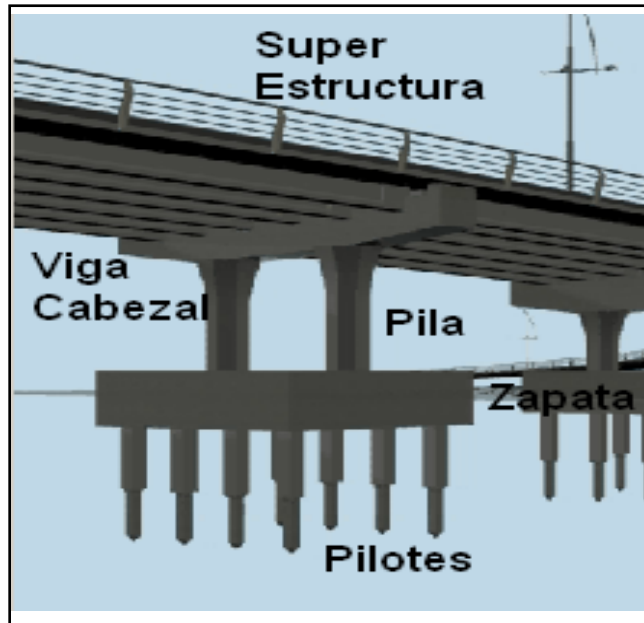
Vista en elevación del Acceso puente de Bahía-San Vicente (CEE, 2008)
